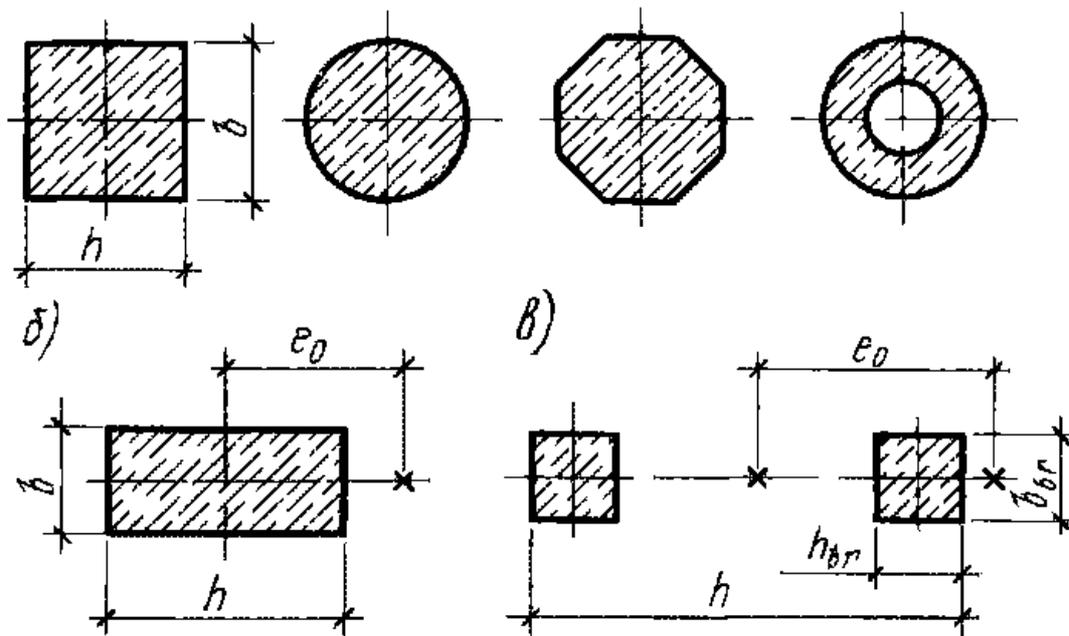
Поперечные сечения и армирование сжатых элементов при малых(а), больших(б) и особенно больших (в) эксцентриситетах.
